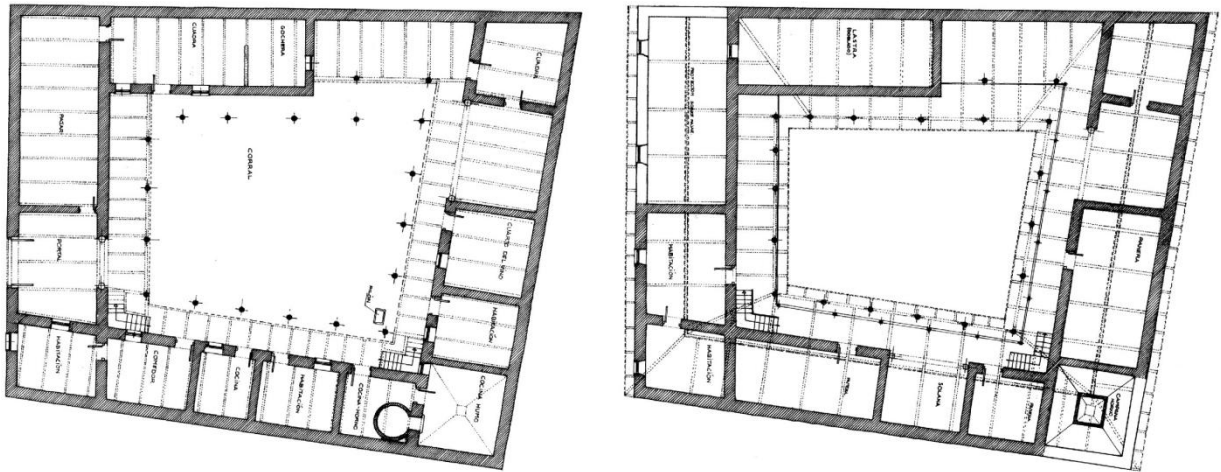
Plantas baja y alta de una casa de corral (ejemplo-2) [10]
